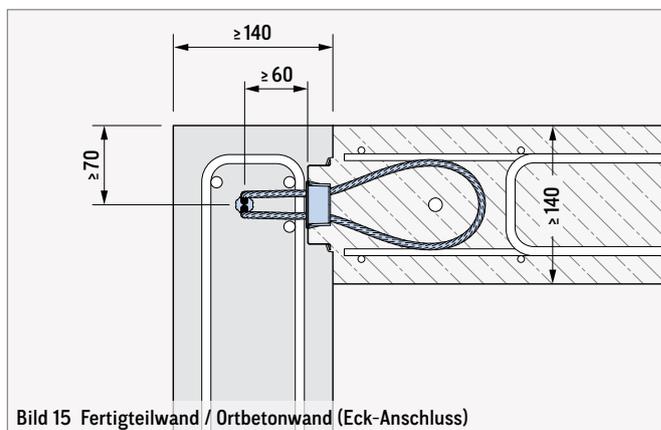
Fertigteilwand / Ortbetonwand (Eck-Anschluss)
